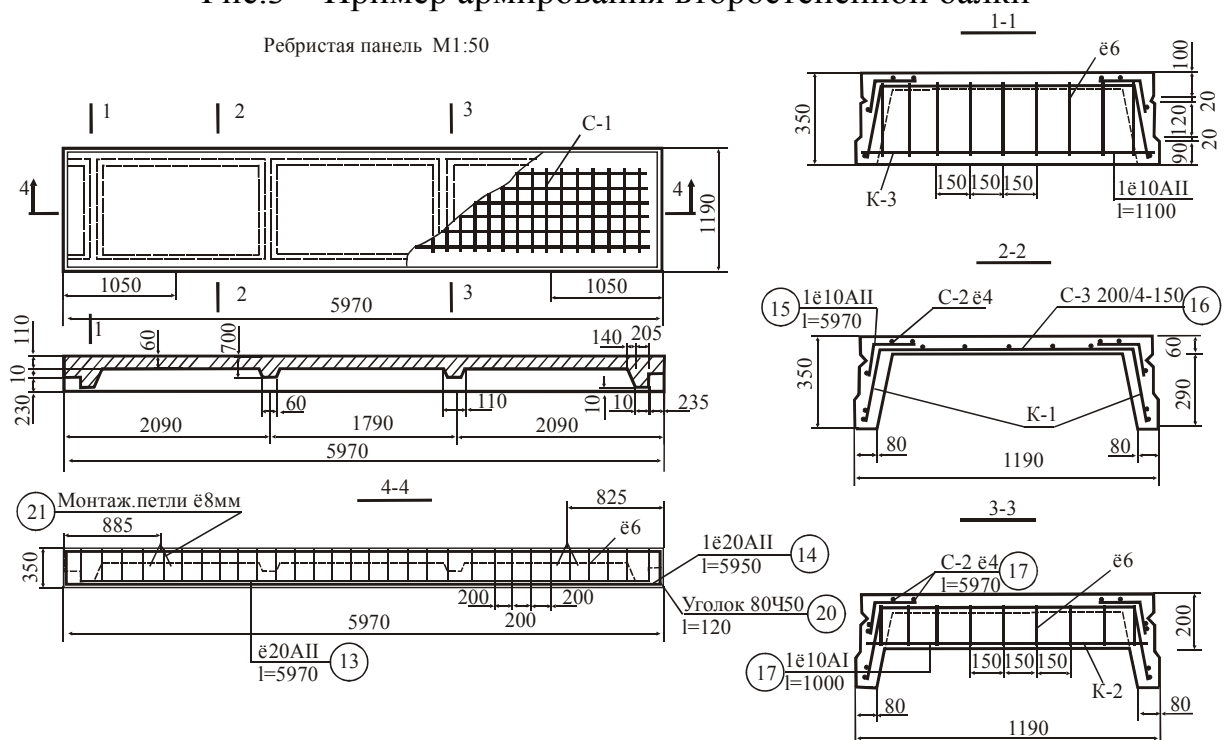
Пример армирования сборной ребристой плиты перекрытия
